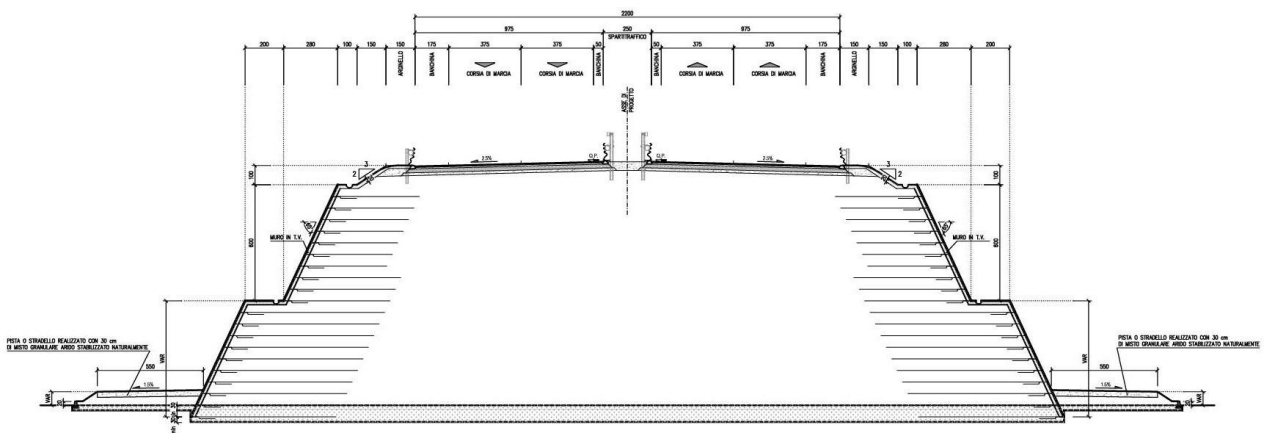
Sezione su rilevato - terra rinforzata – con stradello
